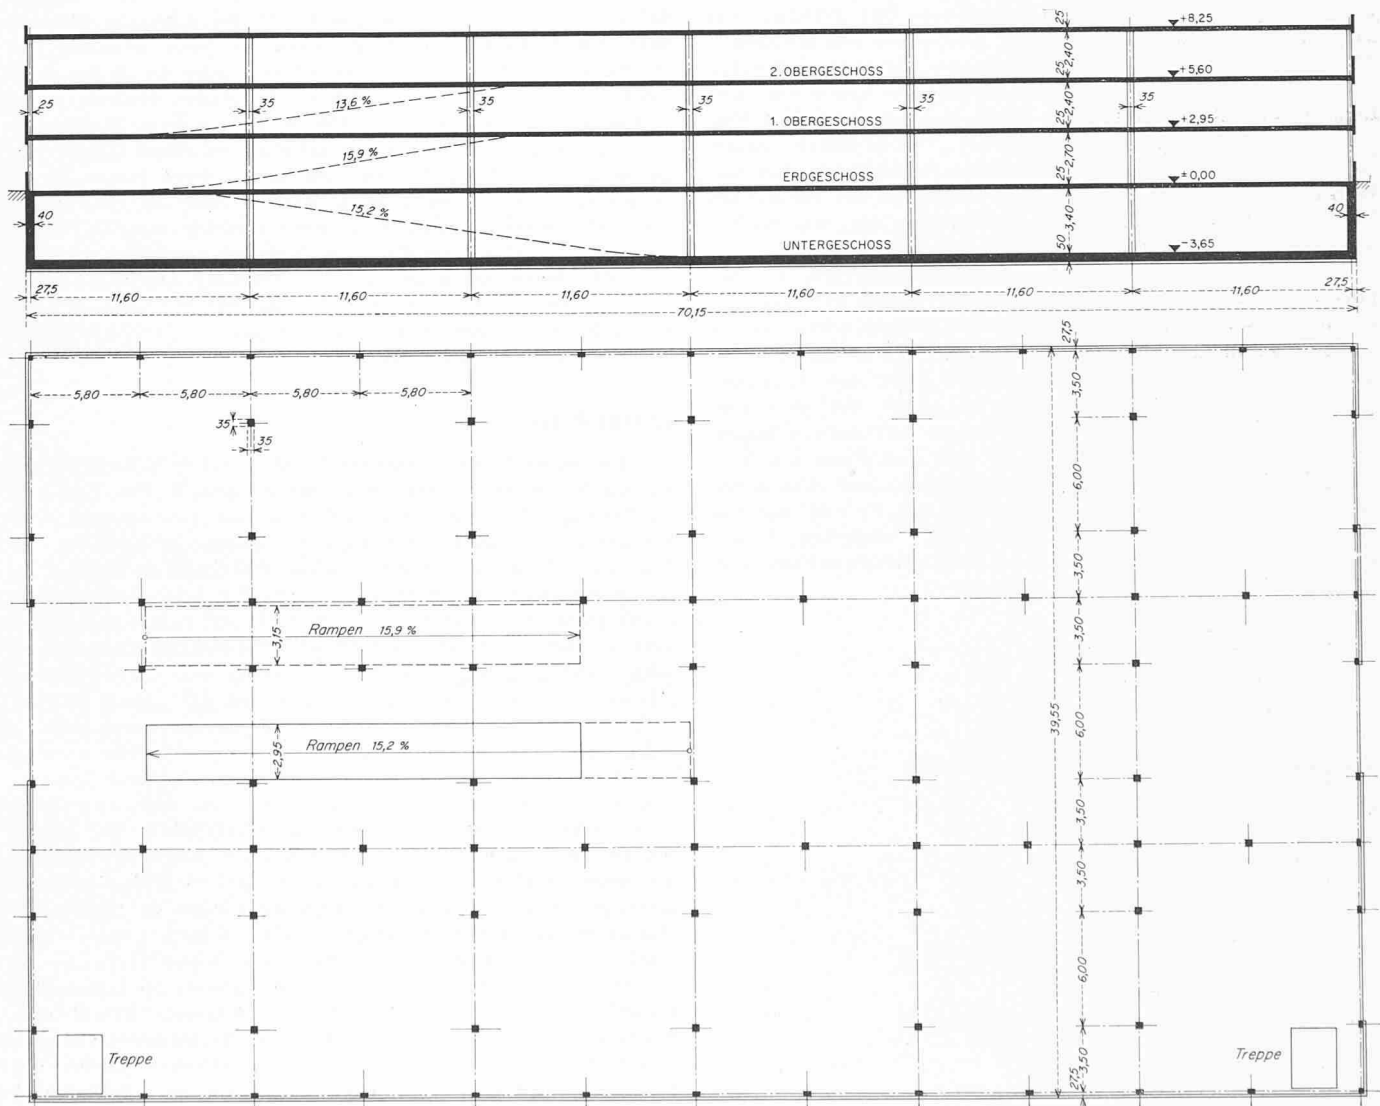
Längsschnitt und Grundriss Erdgeschoss, 1:400
